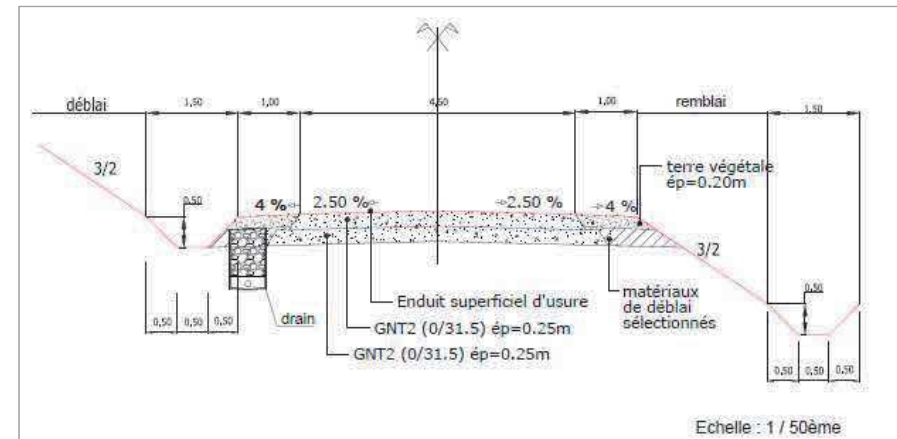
Profil en travers type de la voie des Crouzettes (VC n°16)
